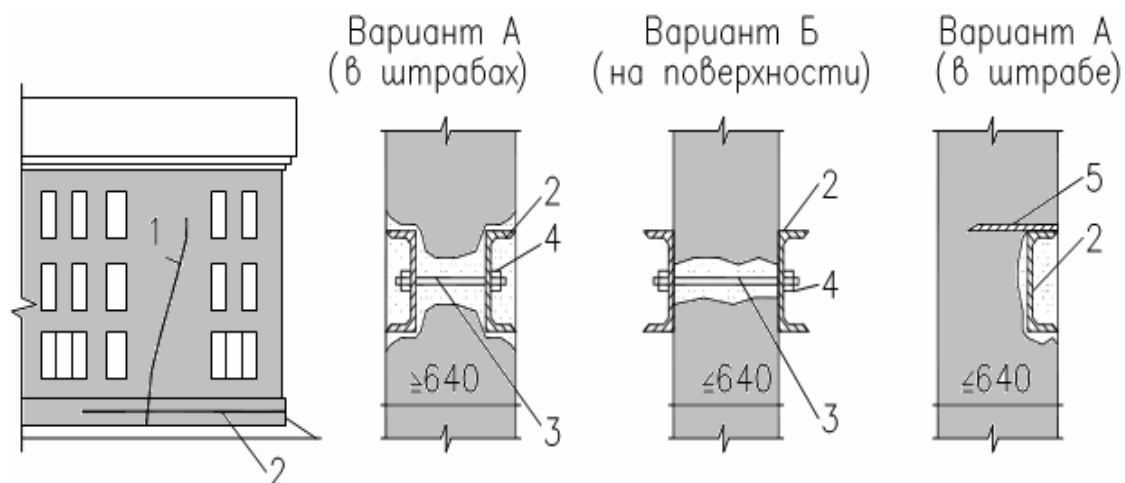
Усиление части здания устройством предварительно напряженного стального пояса из прокатных профилей: 1 – трещина, 2 – пояс из швеллера, 3 – стяжной болт, 4 – гайка, 5 – анкер
